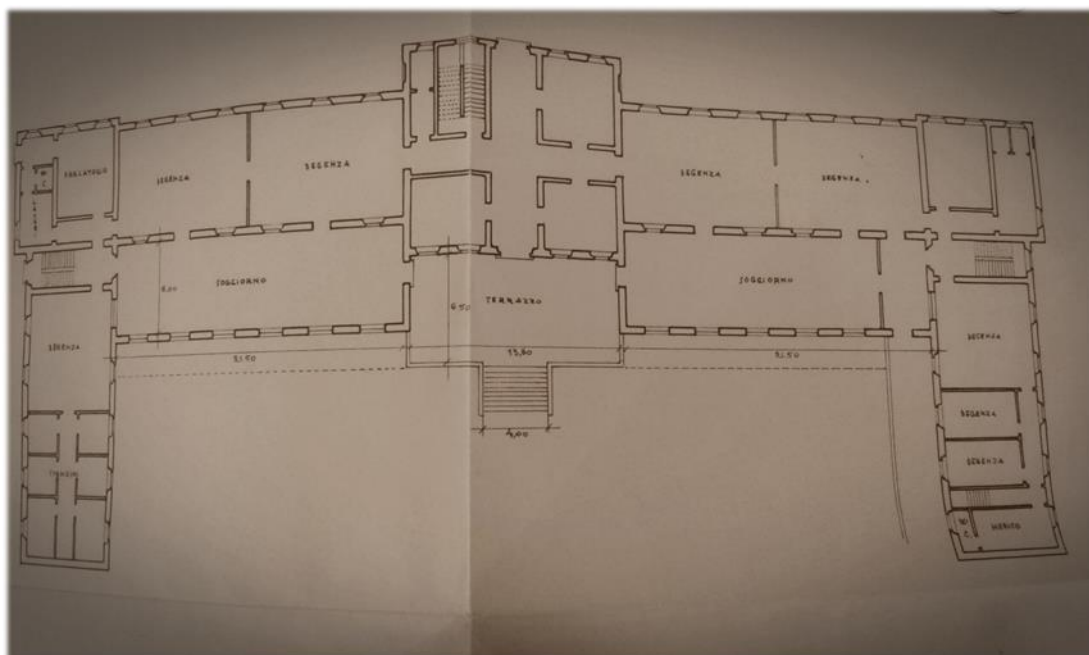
Planimetria della Casa di salute, Archivio Biblioteca di Marostica. Foto S. Fanchin.
